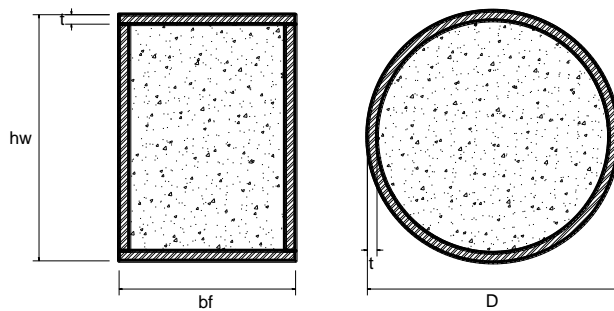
Secciones de acero rellenas de hormigón con nomenclatura de símbolos.
